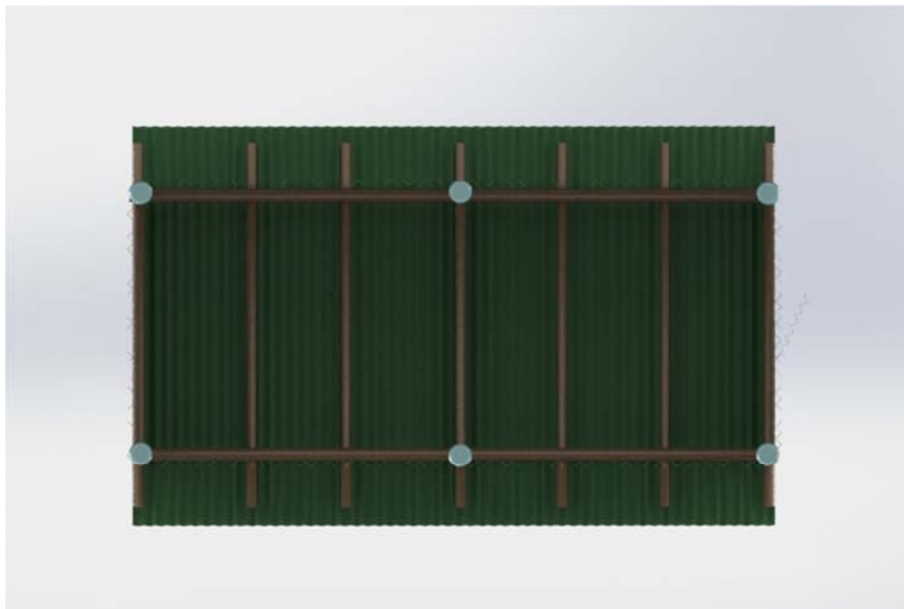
Planta de cubierta cenital. (Fuente: Elaboración propia).
